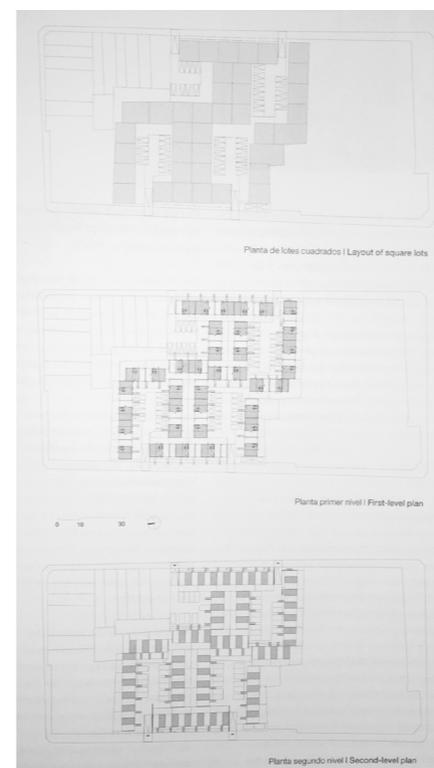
Loteamento, Planta das casas piso terreo, planta apartamentos duplex piso superior.
